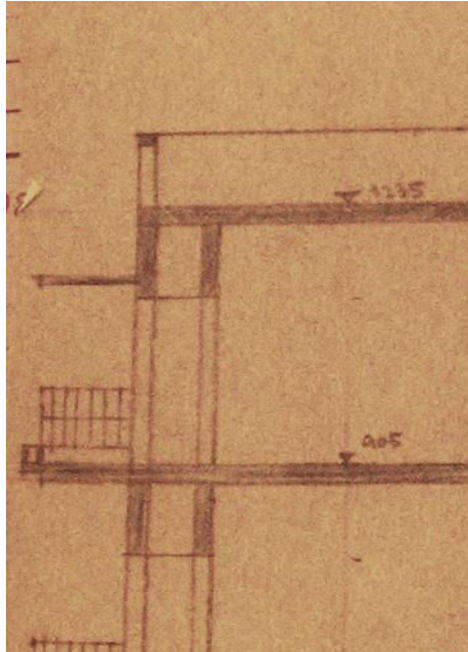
Détail typique de la coupe d'un balcon mi-enfoncé, extrait du permis de construire du 9 rue Luria 12.5.1939. Planifié par l'ingénieur M. Goldenberg
